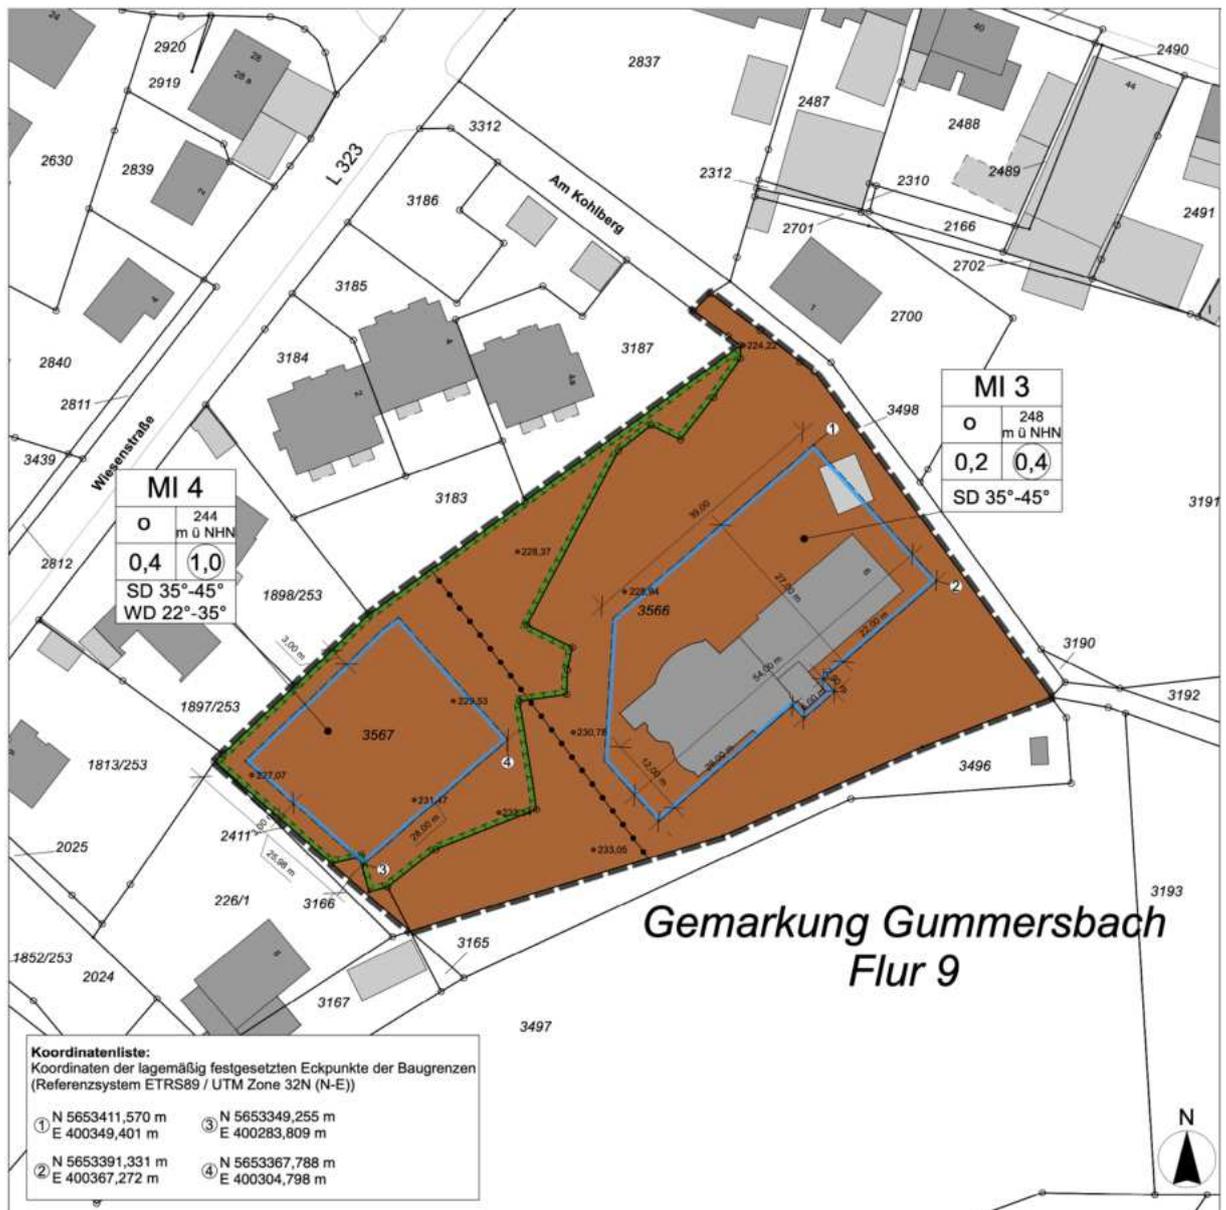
Entwurf der Bebauungsplanänderung (Quelle: Loth Städtebau + Stadtplanung, 2023)
